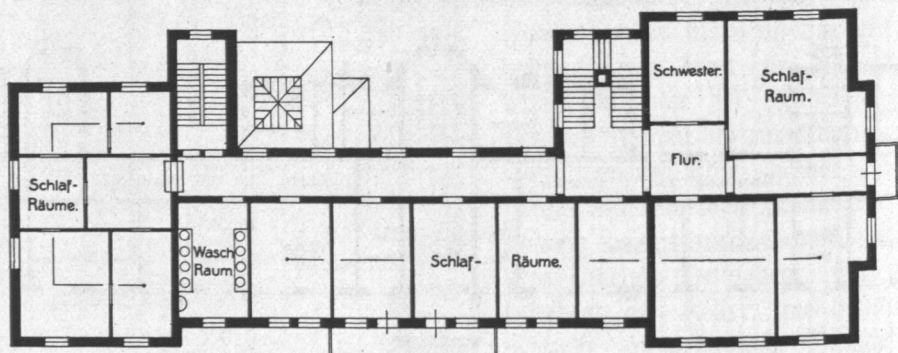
Genesungs- und Erholungsheim Groß-Hansdorf, Gebäude für Frauen, Obergeschoß, Grundriß.
